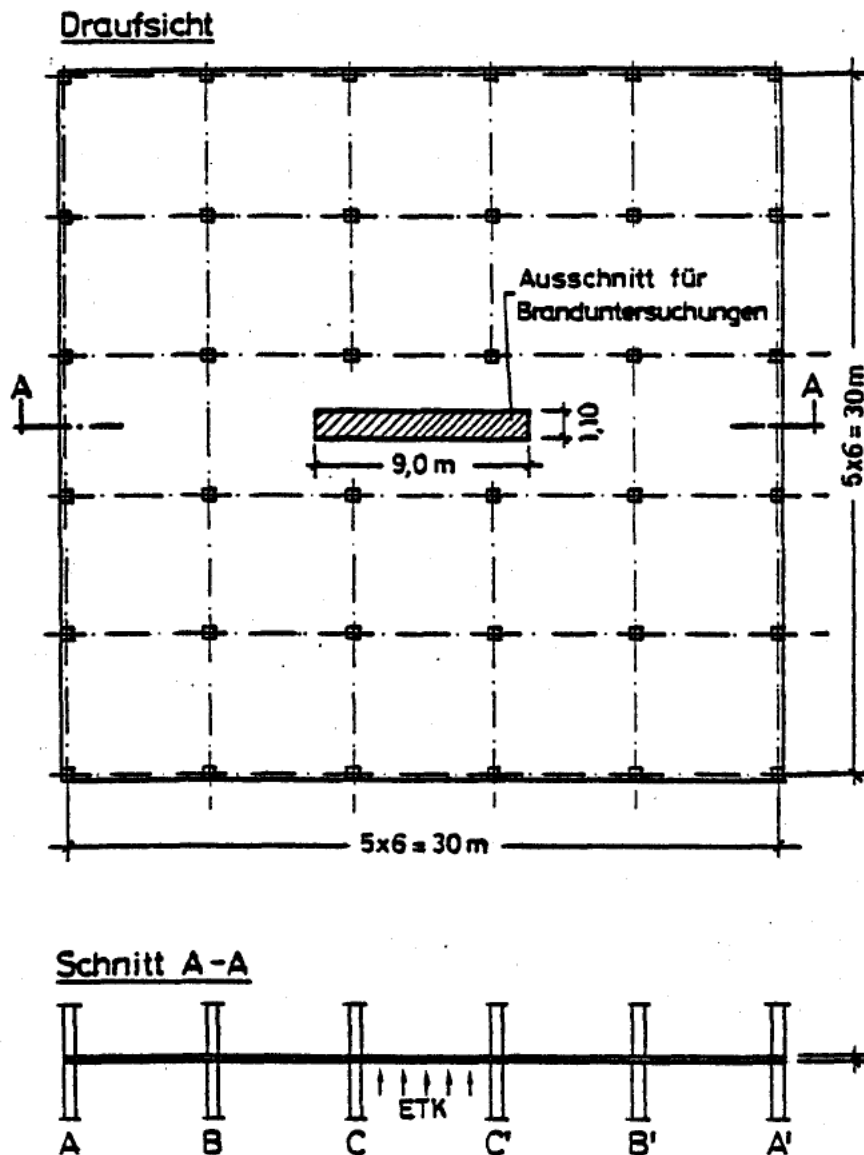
Zugrundegelegte Gesamtkonstruktion und der im Brandversuch geprüfte Ausschnitt
